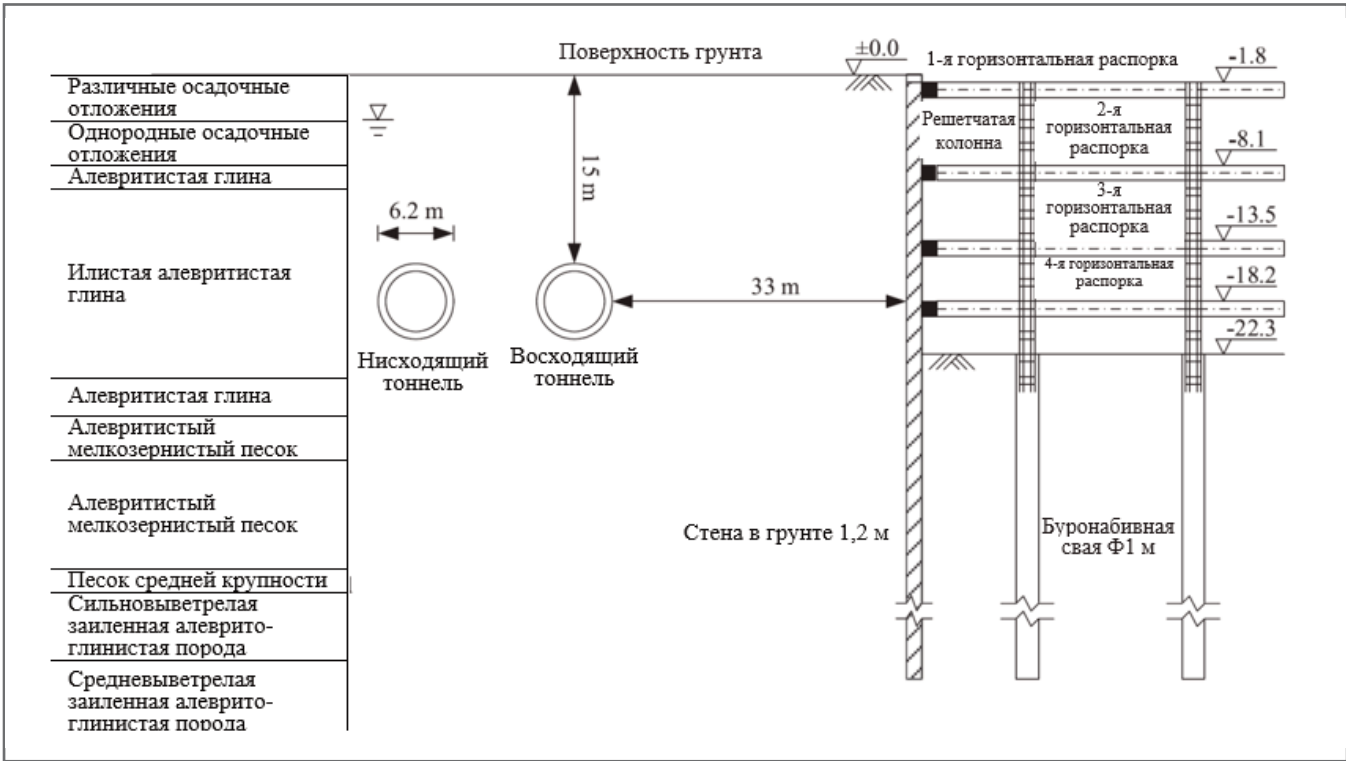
Поперечное сечение тоннелей и выемки под фундамент
